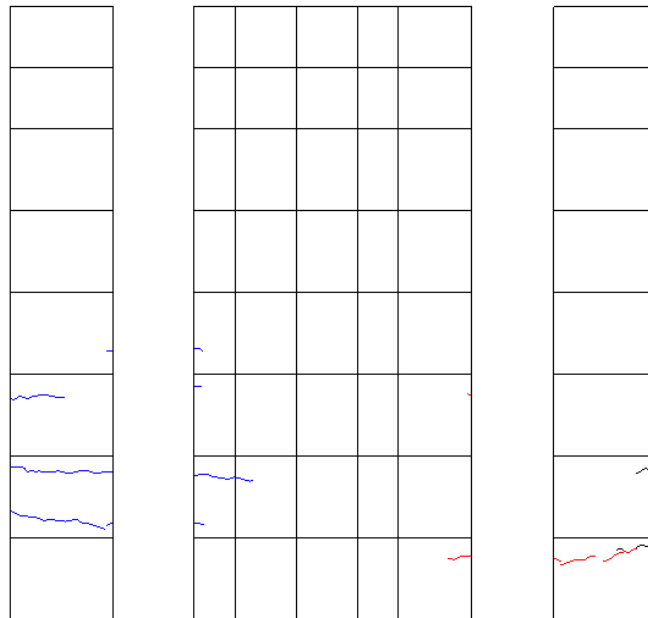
R=1/800 ひび割れ図
